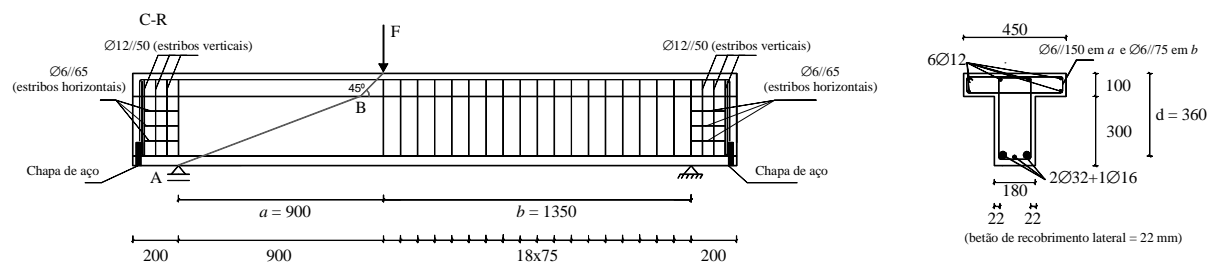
Geometria, tipo de ensaio e armaduras de aço comuns a todas as vigas ensaiadas (dimensões em mm).
